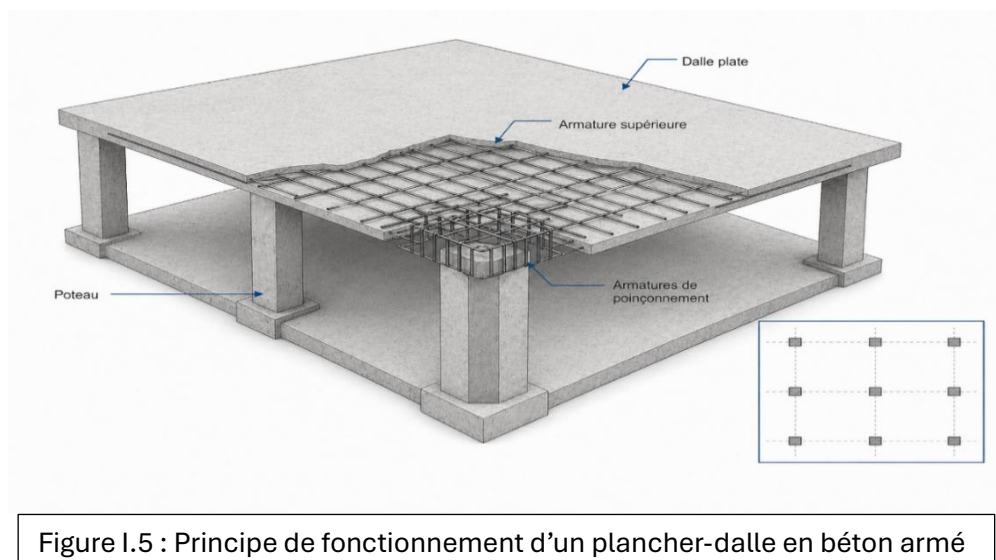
Principe de fonctionnement d'un plancher-dalle en béton armé
